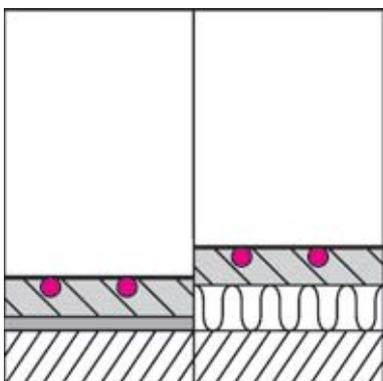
Bodenkonstruktion TB2 mit Trockenestrichplatten (TE)
